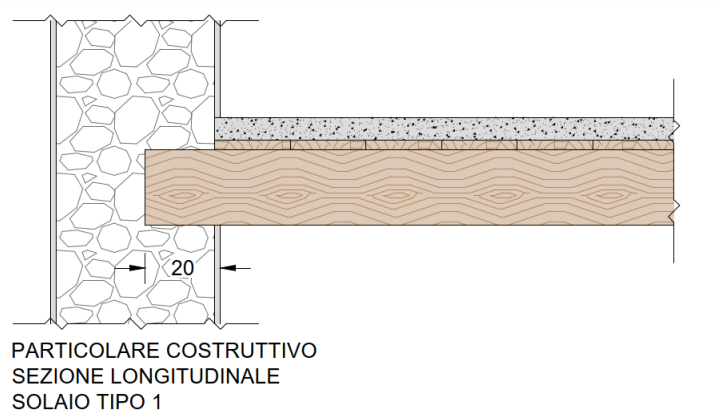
Particolare costruttivo Solaio tipologia 1 - Sezione longitudinale
